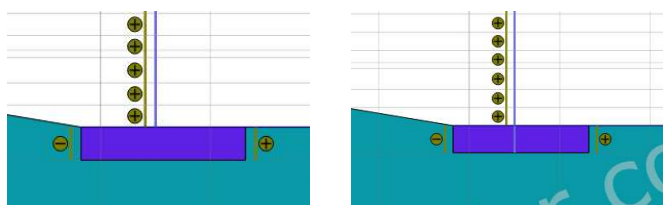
Zatěžovací zkouška – příčný řez.
